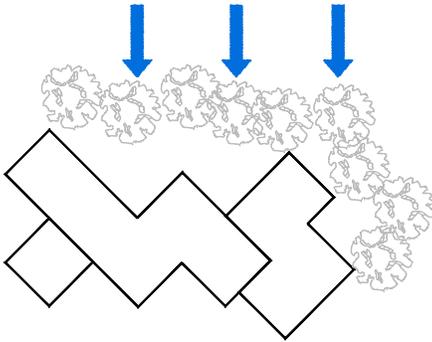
| Aprovechamiento de las fachadas del sur para captación del sol y protección de los vientos del norte.
